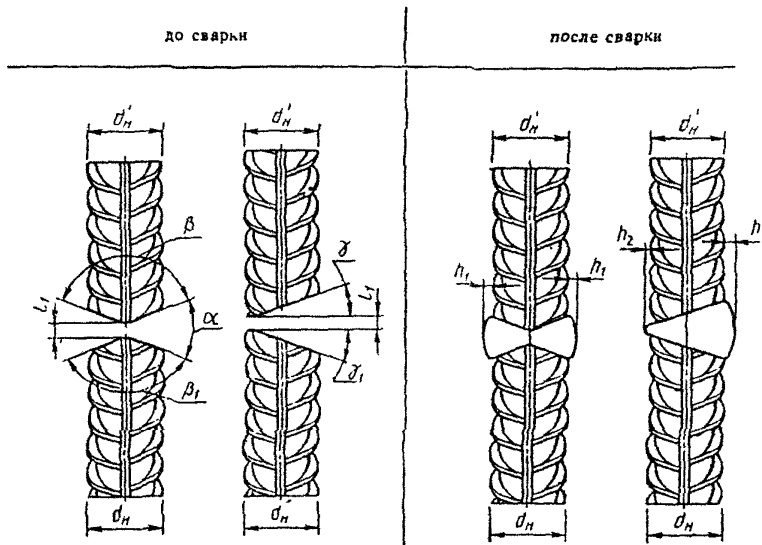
Конструкция стыковых соединений с односторонней и двусторонней разделкой торцов вертикальных стержней, выполняемых ручной дуговой сваркой многослойными швами (тип С20-Рм)
